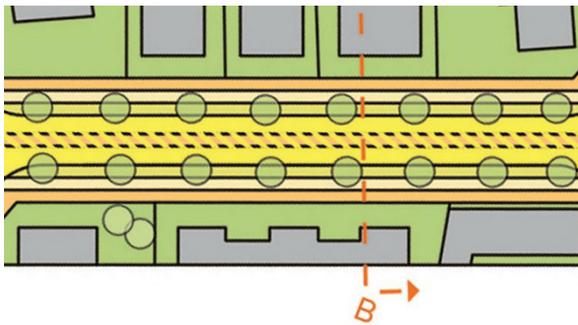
Straßenprofil Wiener Straße, Stadtareal Baden
